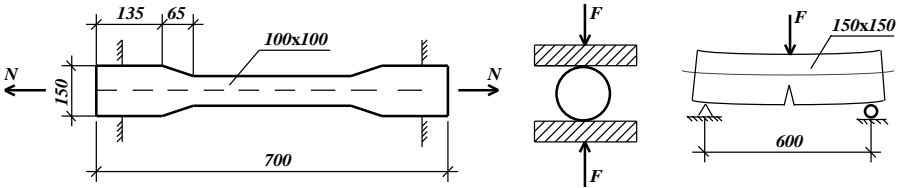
Схеми випробовування зразків для визначення міцності бетону на розтяг
